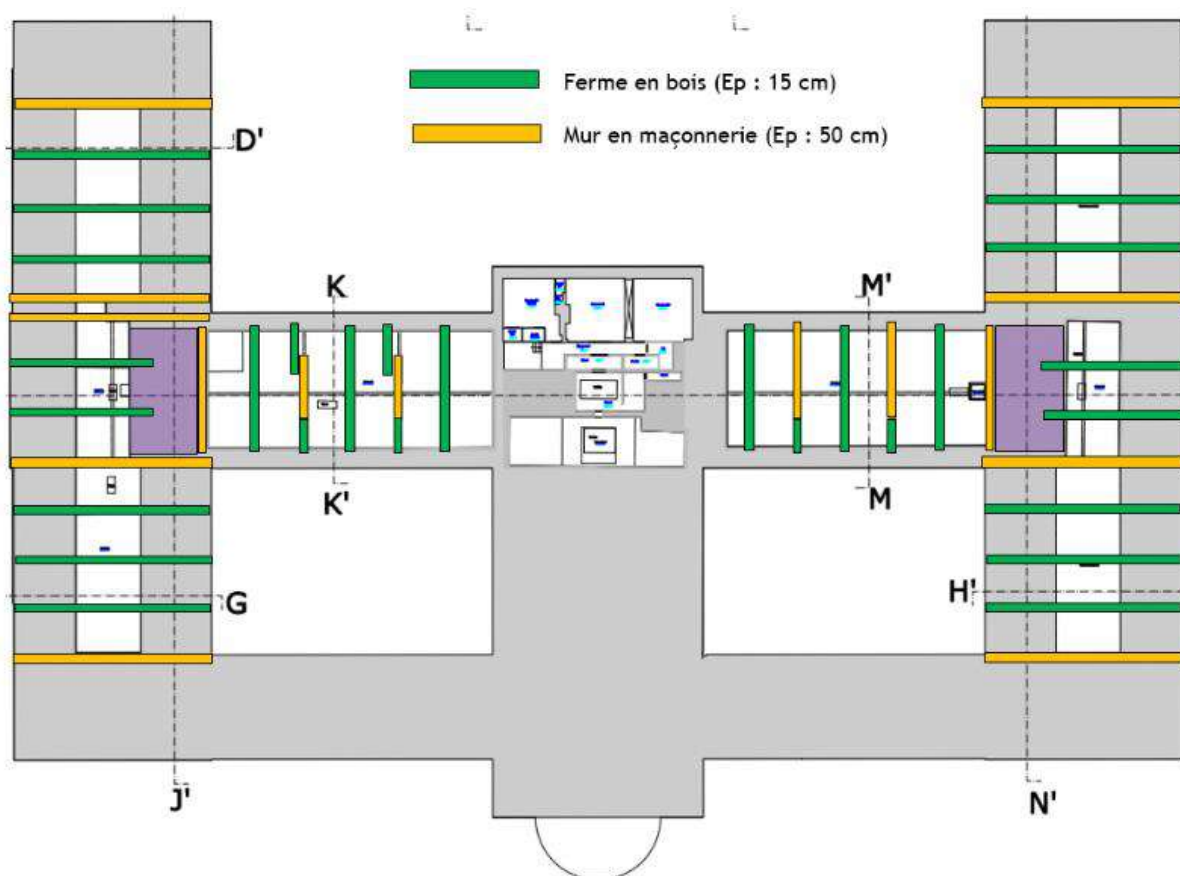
Plan des principes structurels sur fond de plan géomètre des combles
